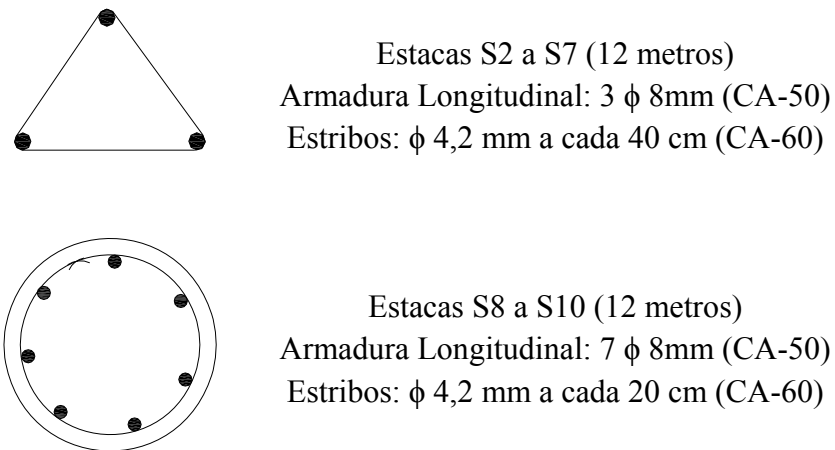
Detalhes das armações das estacas Strauss ensaiadas
